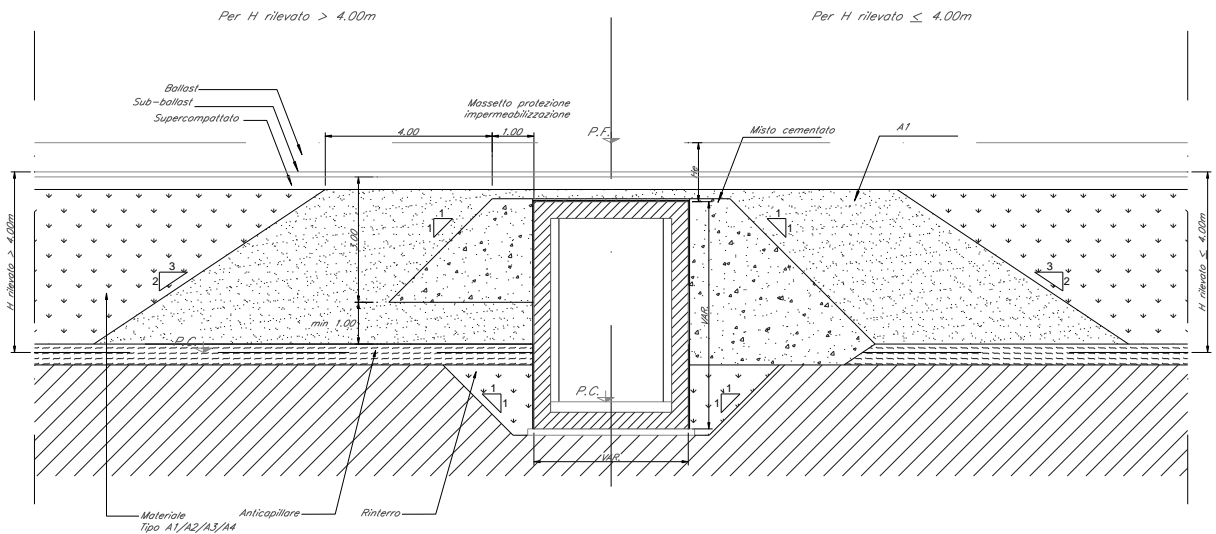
Zona di transizione rilevato-scatolare con  $1,55 < H_e \leq 2,50$  m
